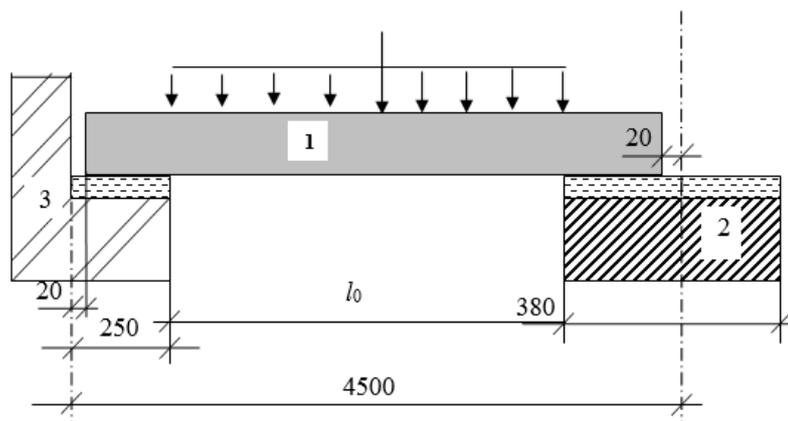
Схема опирания балки: 1 – железобетонная балка; 2 – кирпичная колонна; 3 – пилястра
